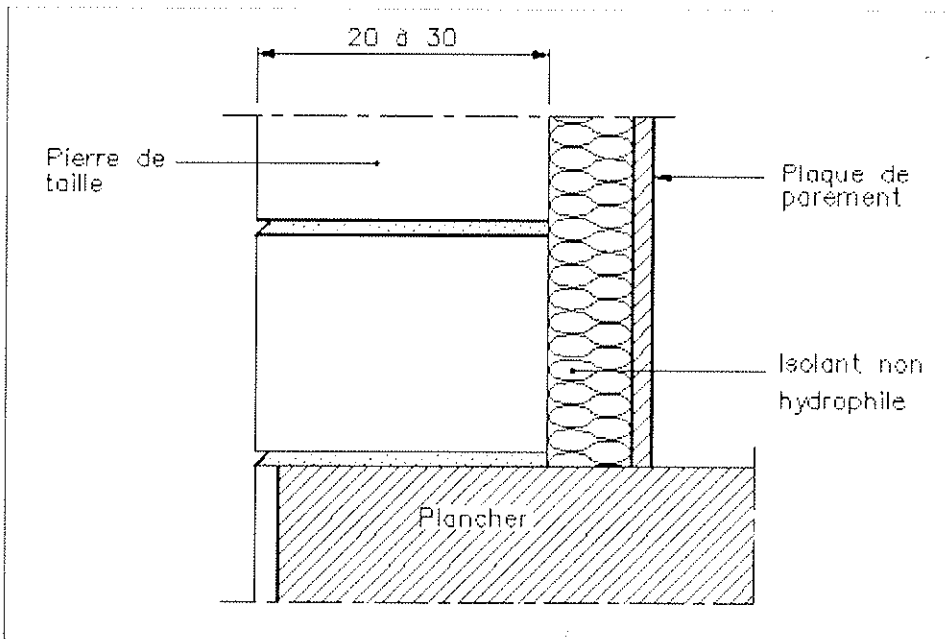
Moellons taillés ou pierre de taille/murs du type IIa/épaisseur minimale de la paroi extérieure en pierre
